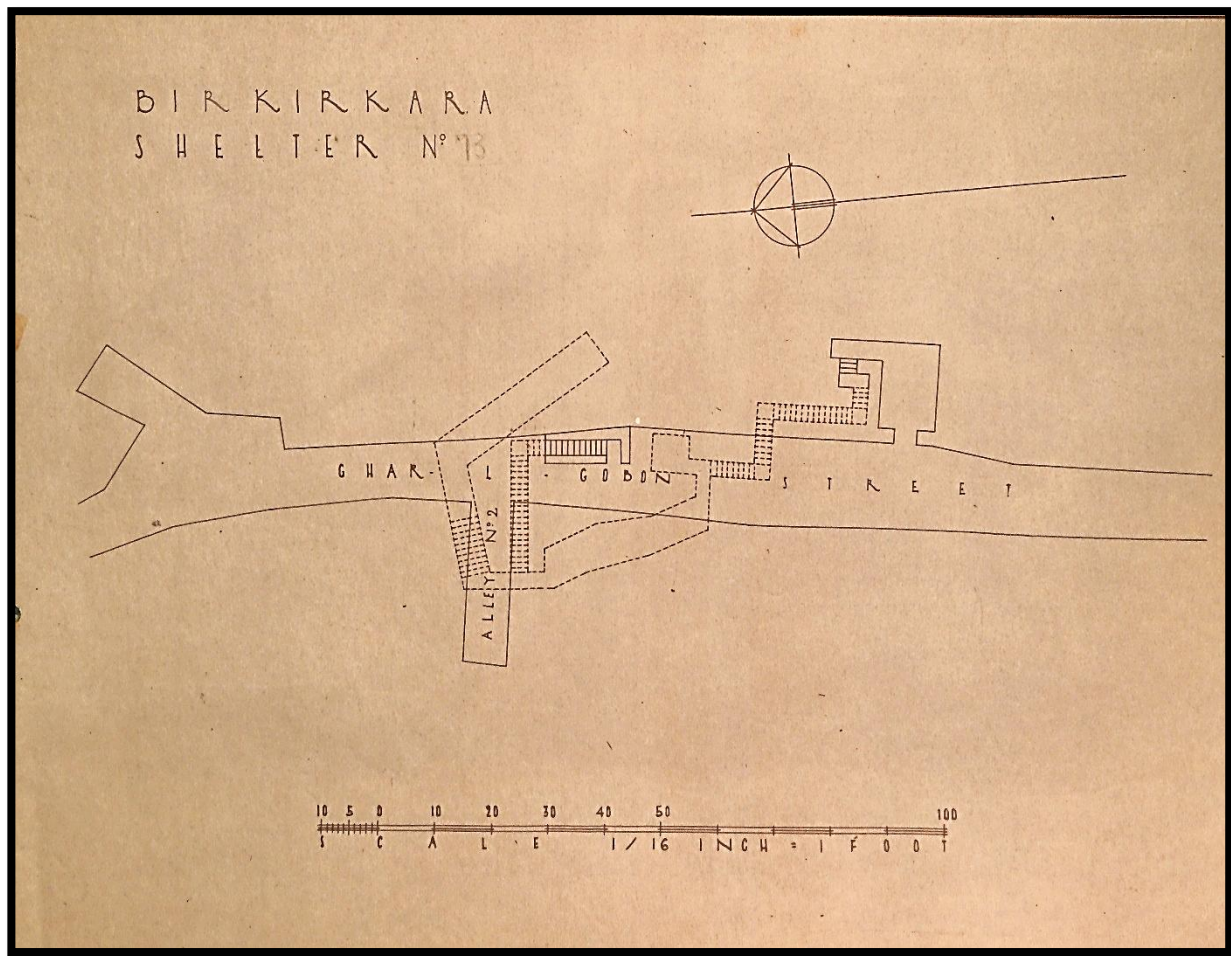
Planta do Abrigo nº 13 "Għar -il – Gobon Street – Alley nº2."
